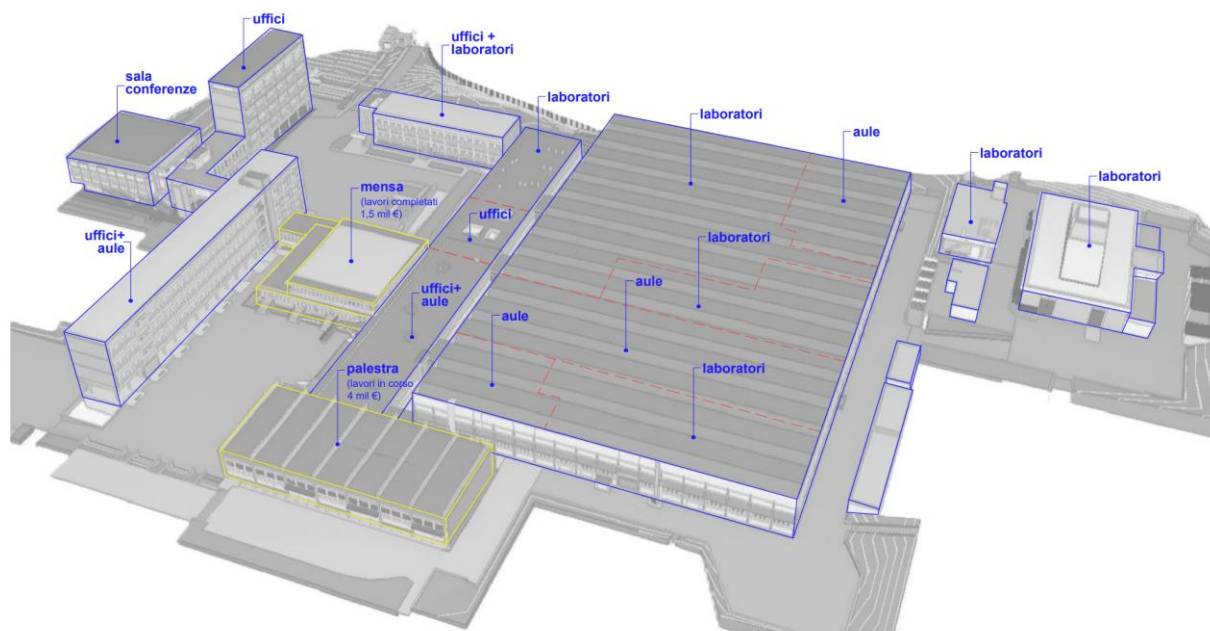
Planivolumetrico del complesso immobiliare di Pentima, con individuazione dei blocchi edificati.
